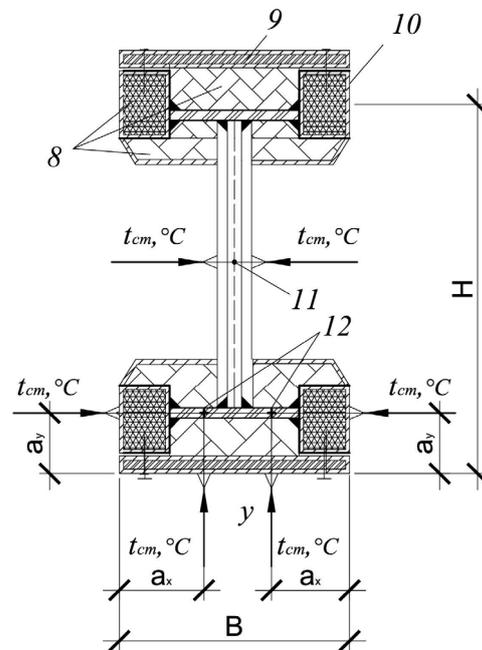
Сечение стальной балки с гофрированной стенкой с заполнением термозащитных поясов; обогрев балки с четырех граней
